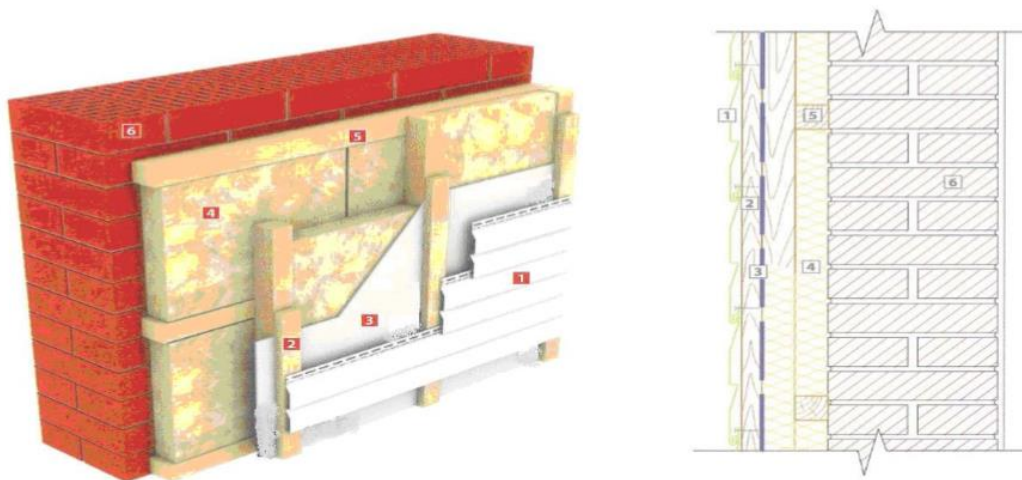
Фасадна система з облицюванням вініловим сайдінгом:
